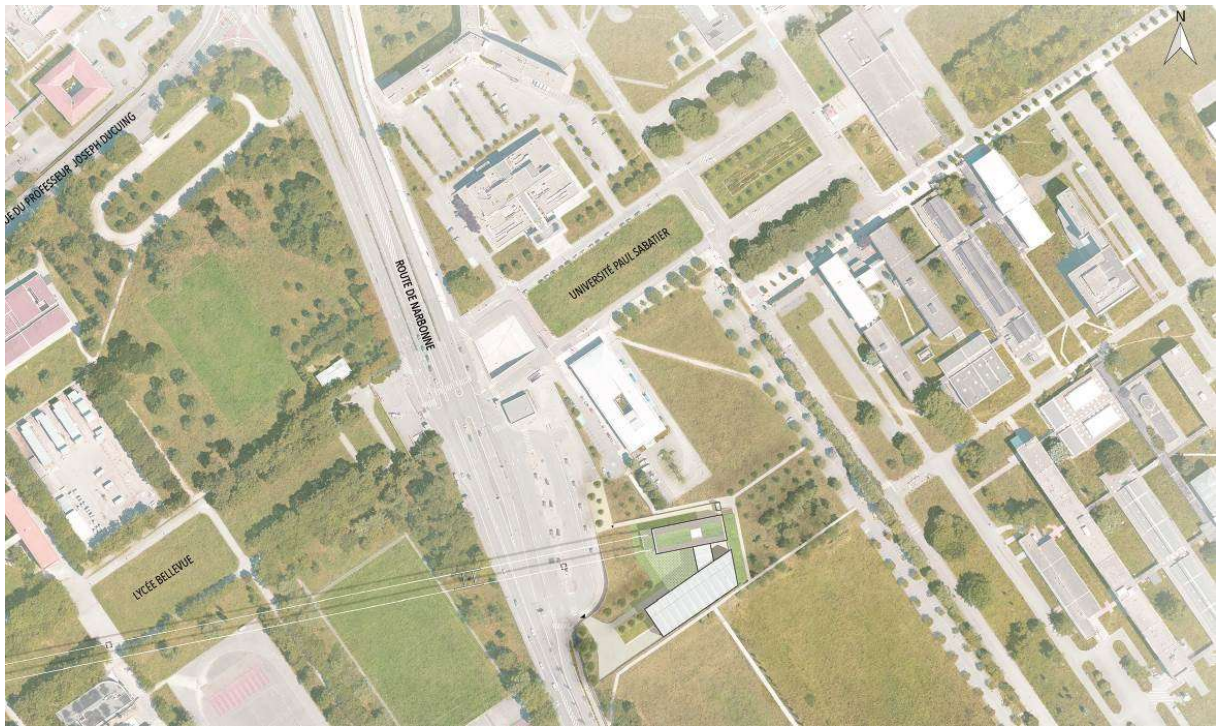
Plan de masse de la station UPS (source : Groupement POMA, 2018)
